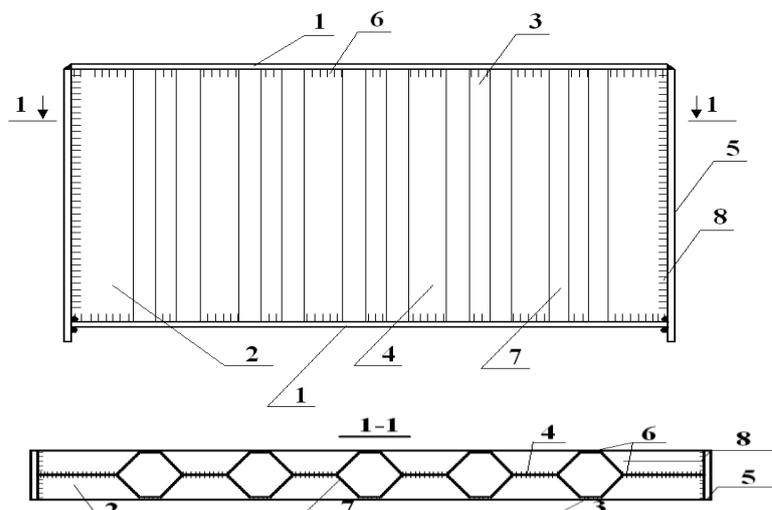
Сталева балка з поперечно профільованою стінкою коробчастого перерізу з переривчастими поясними швами
